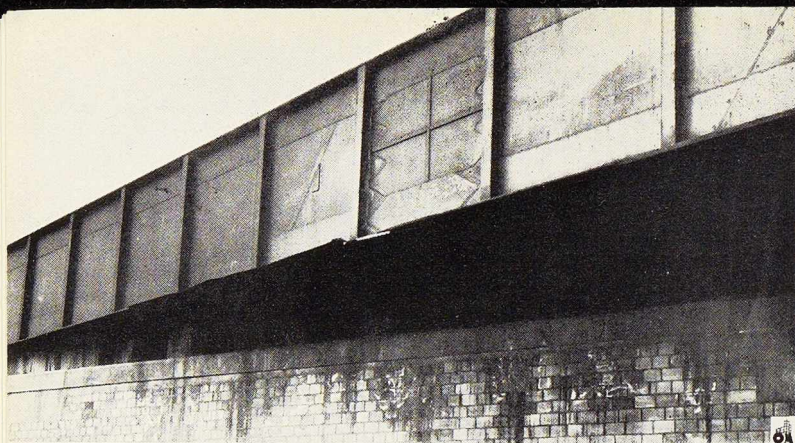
Pont de la plaine Saint-Denis réparé par soudure à l'arc pratiquée sur place (suite à un bombardement pendant la guerre).
